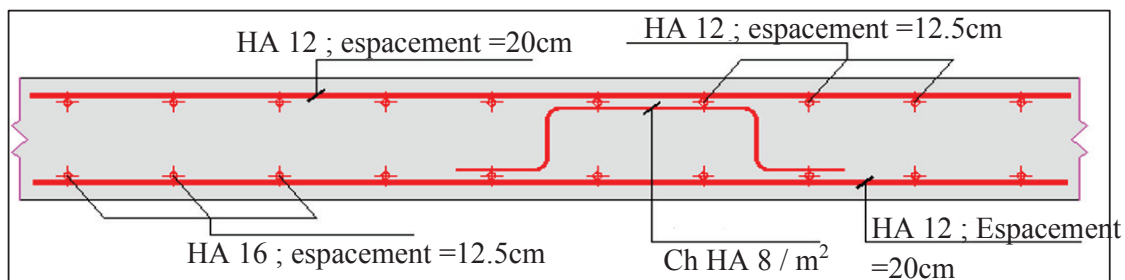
La coupe longitudinale de Ferraillage de la dalle de transition
